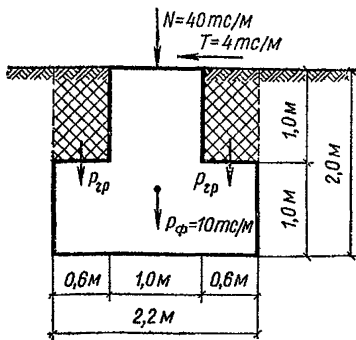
Предварительные размеры ленточного фундамента для примера определения коэффициента устойчивости способом «круга трения»
